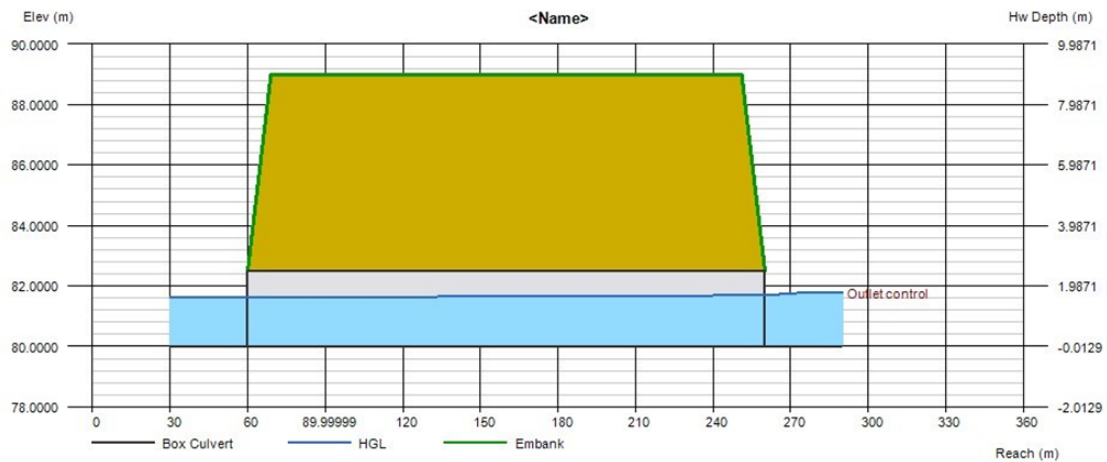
Modelamiento de cajón de 2500 x 2500 mm de concreto reforzado.
